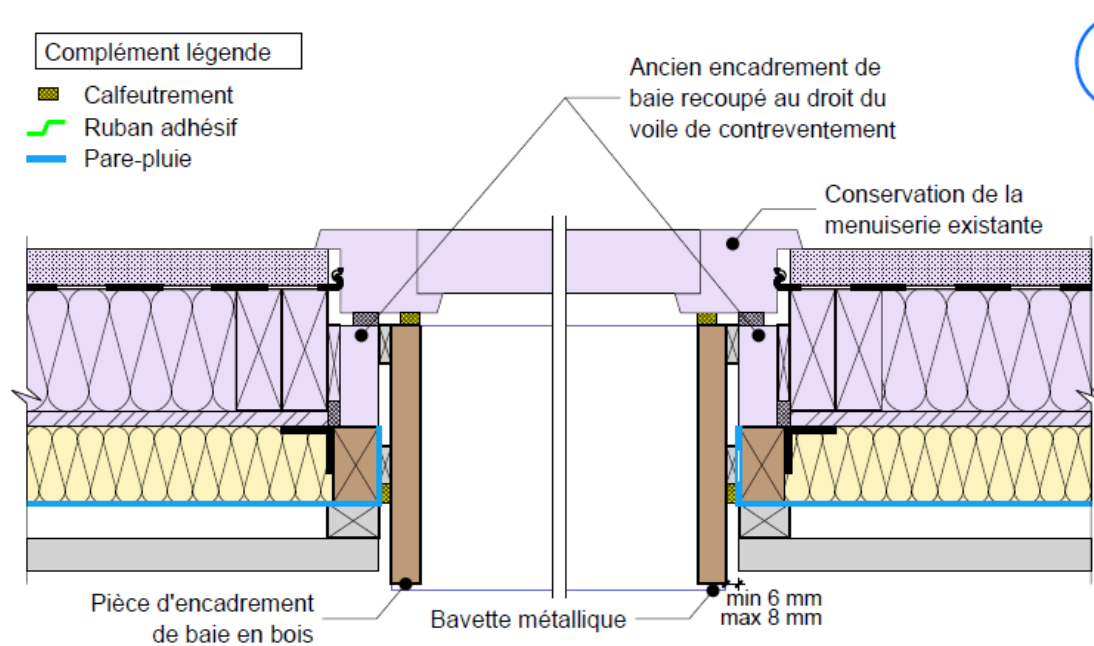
Baie avec encadrement rapporté en bois (coupe horizontale)
